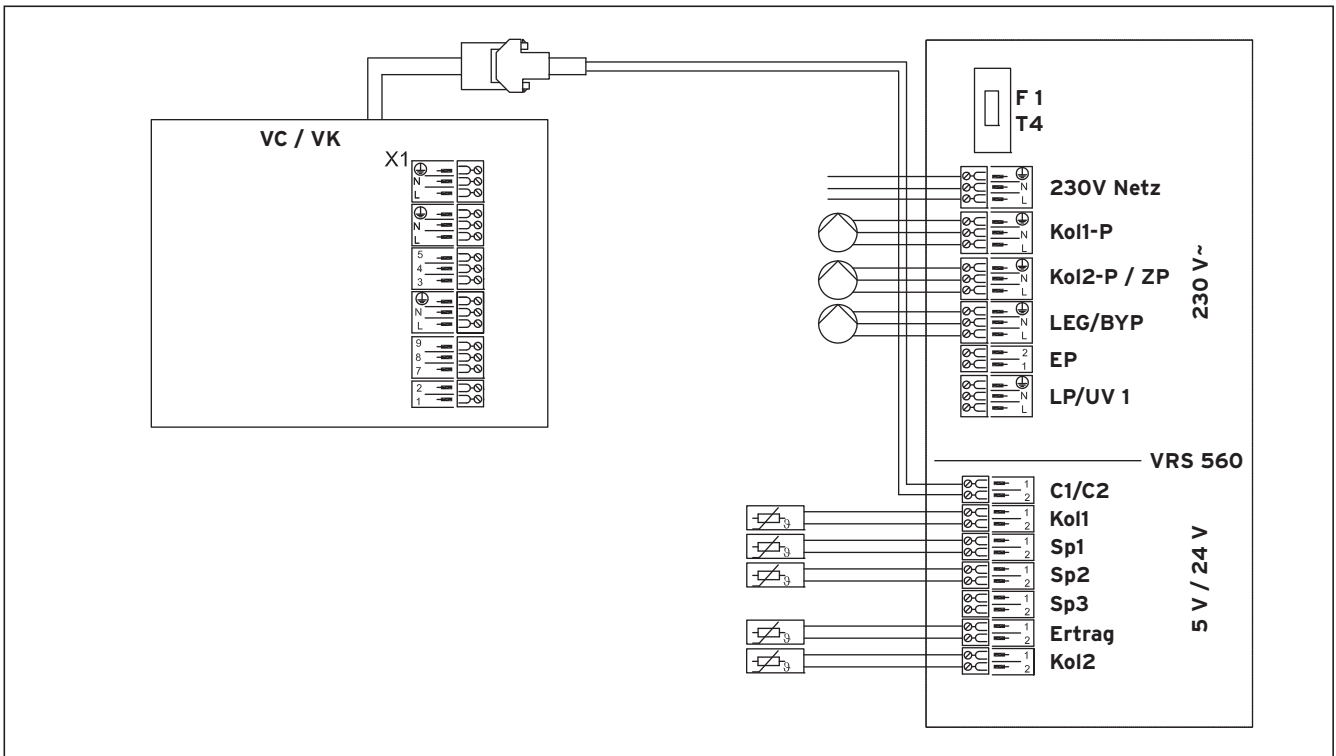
Plan de raccordement pour schéma hydraulique 3
